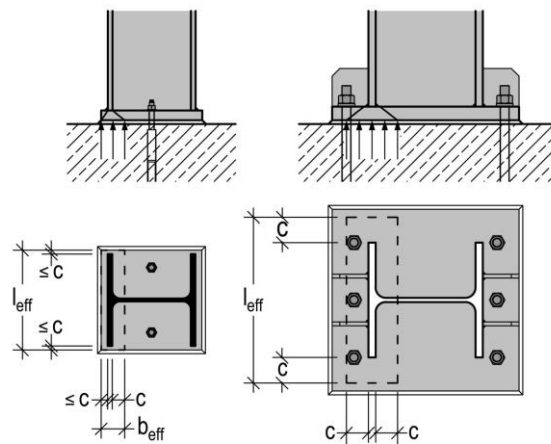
Berechnung der Ausbreitungsfläche des T-Stummels mit geringem (links) und großem Ankerplattenüberstand (rechts)
